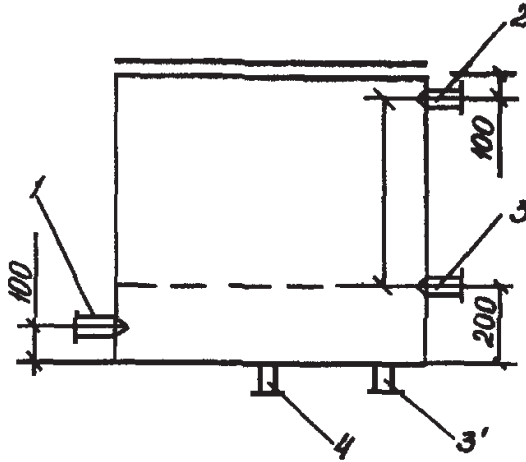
Відкритий розширювальний бак з патрубками для приєднання труб: 1 – розширювальний; 2 – переливний; 3 – контрольний (3’ – реле рівня); 4 – циркуляційний
